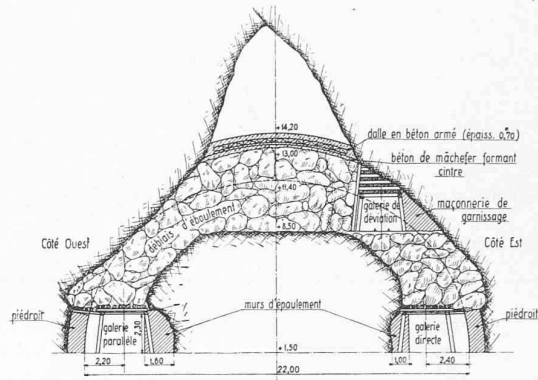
Coupe transversale sur l'anneau 103 au moment de la construction de la dalle armée. Echelle 1 : 400.
